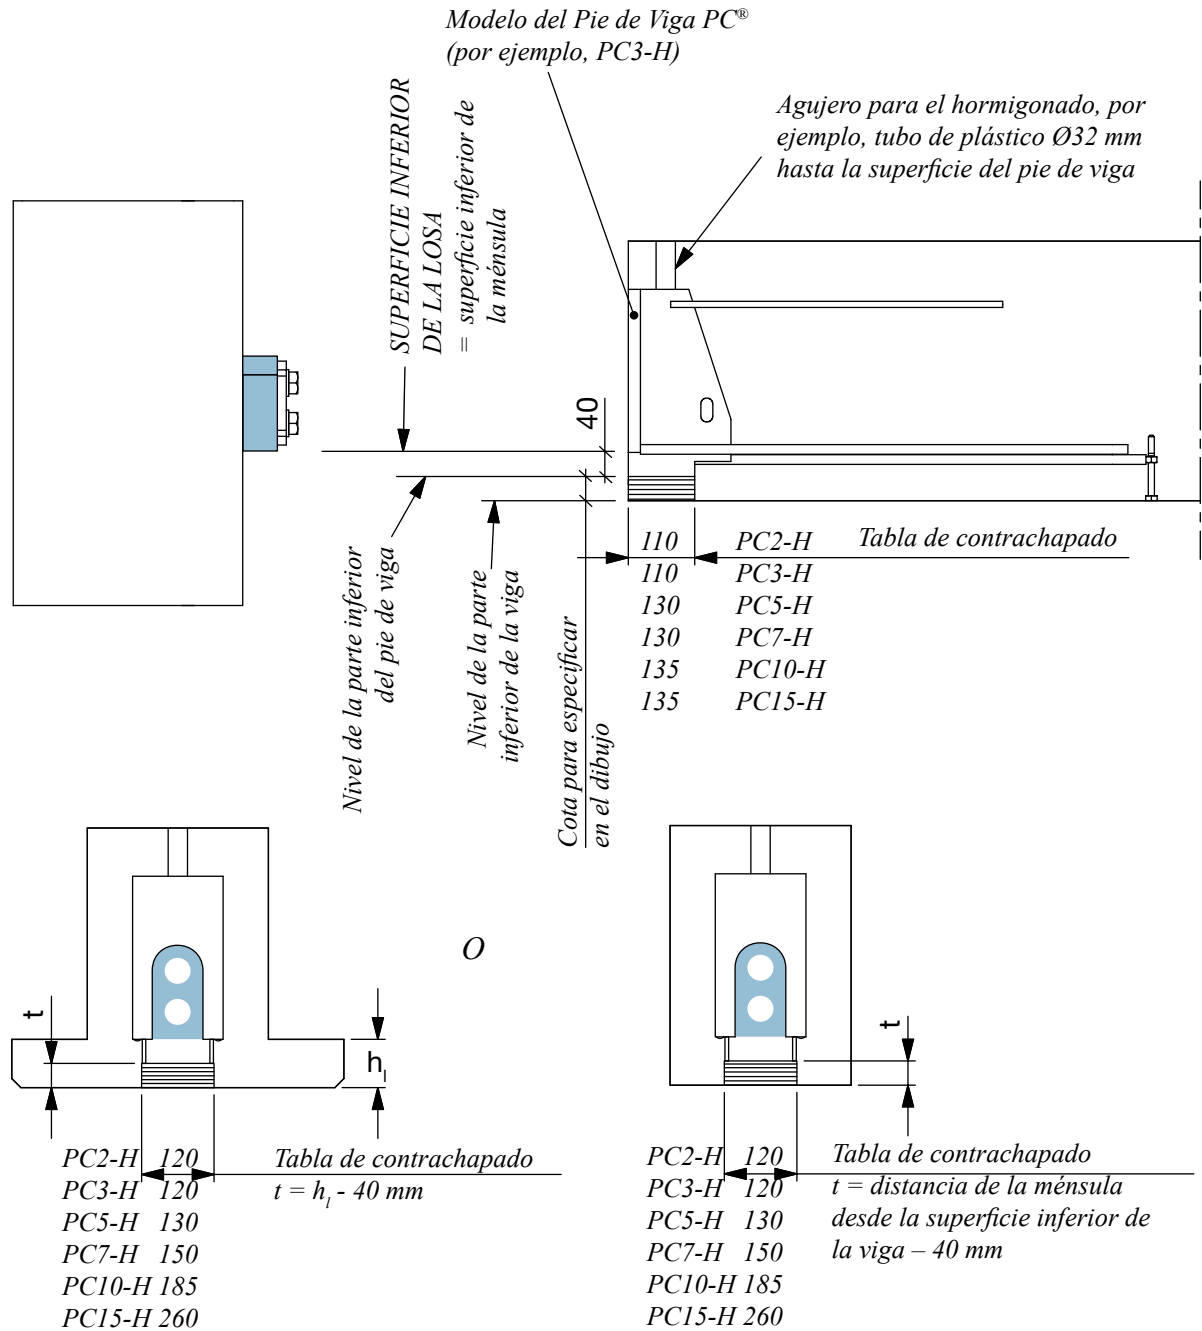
Detalles a especificar en el plano de la viga cuando se utiliza el pie de viga PC®-H.
